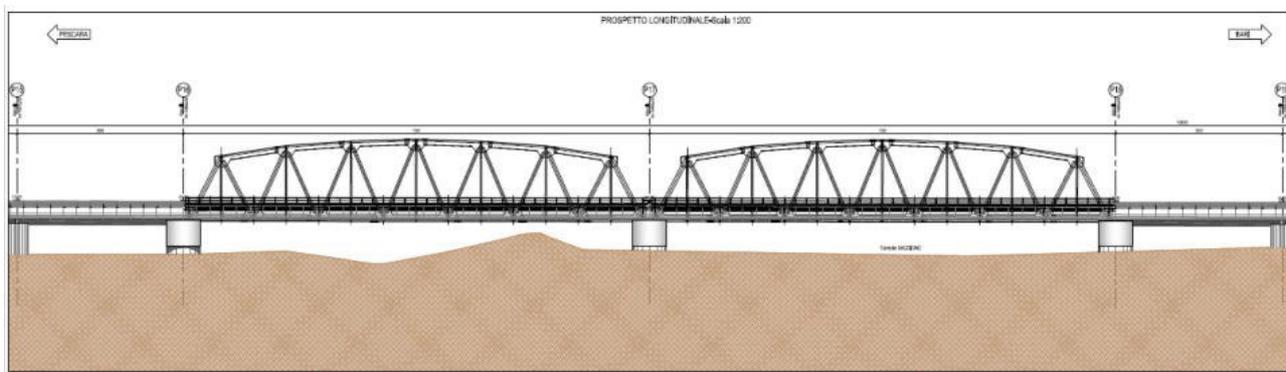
Attraversamento del Torrente Saccione – Impalcato con travate metalliche reticolari a via inferiore di luce L=70 m
